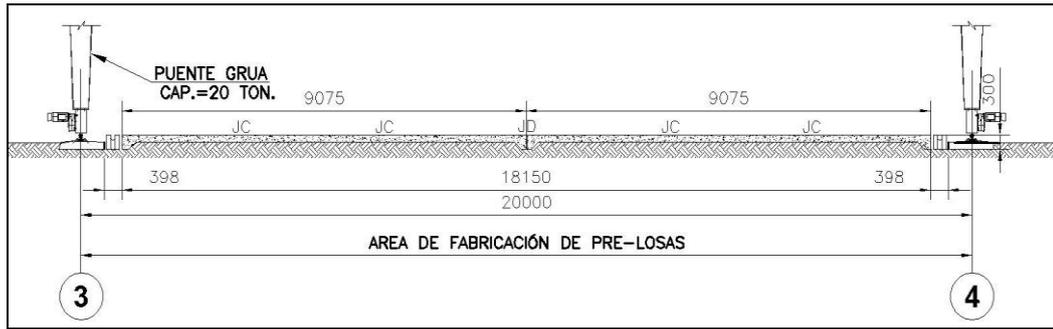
Muestra la sección de la plataforma de apoyo para fabricación de prelosas
